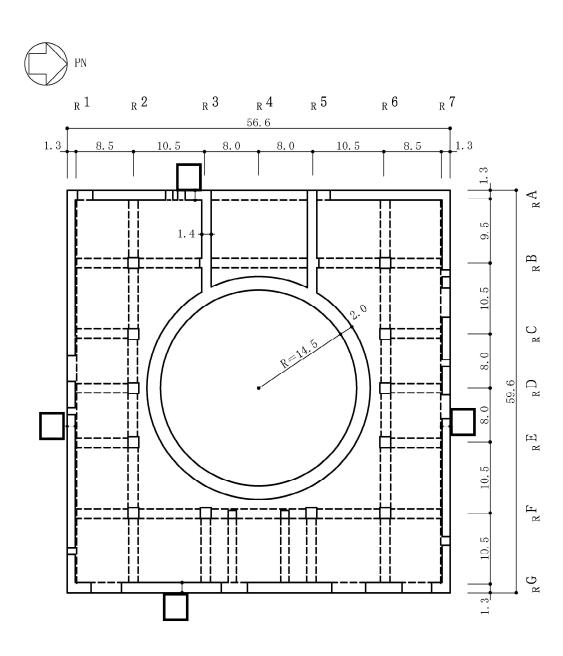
原子炉建屋の概略平面図 (1F, T.M.S.L.12.3m) (4/9) (単位:m)
